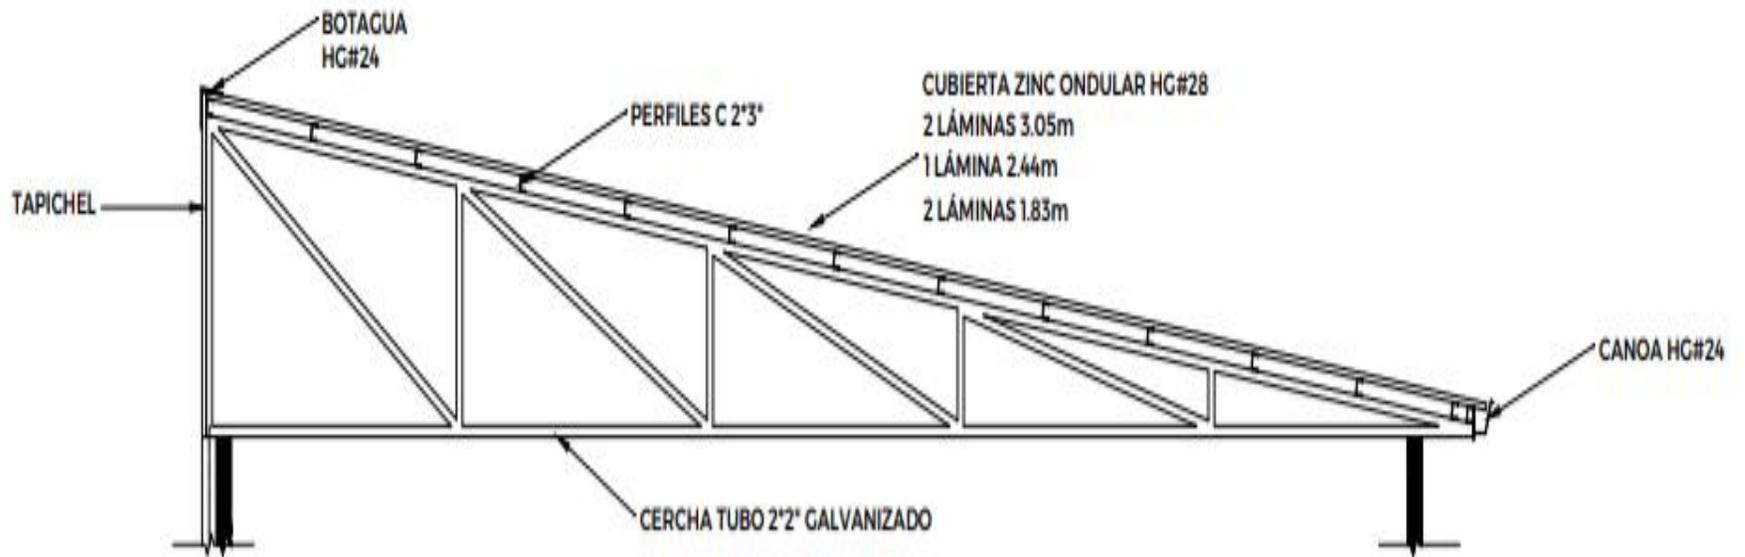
Planta de techos 1 agua - Sistema constructivo Teknoblock -Lamina convencional
